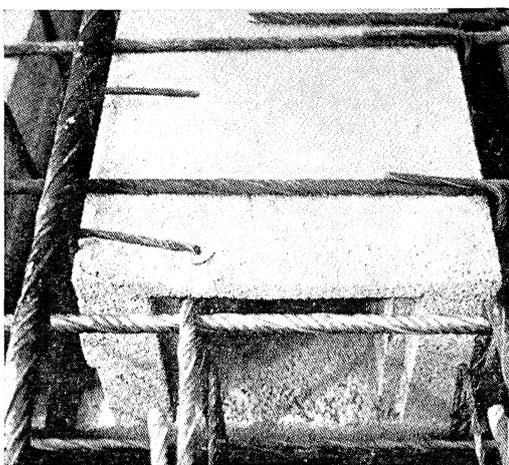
Colocación de elementos de aislamiento acústico para techos en hormigón ligero de Styropor.
